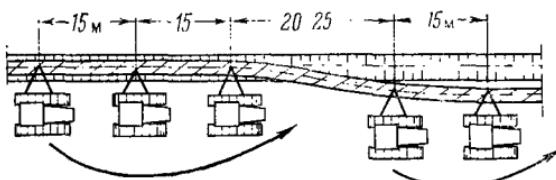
Схема укладки трубопровода, рекомендованная «Союзгазспецстроем»
